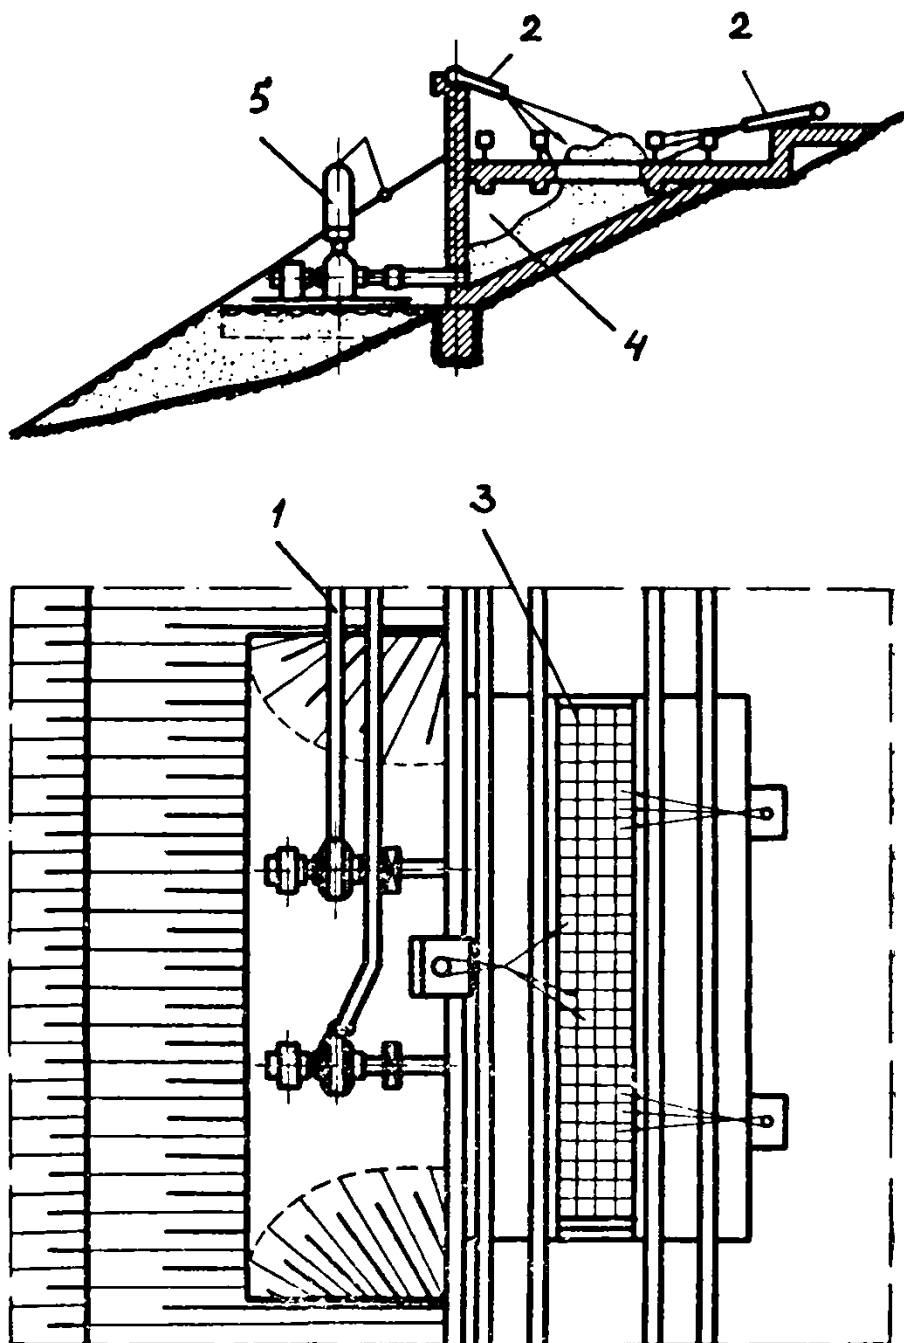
Схема подготовки грунтов к транспортированию при размыве гидромониторами на приемных площадках бункеров [133]:
